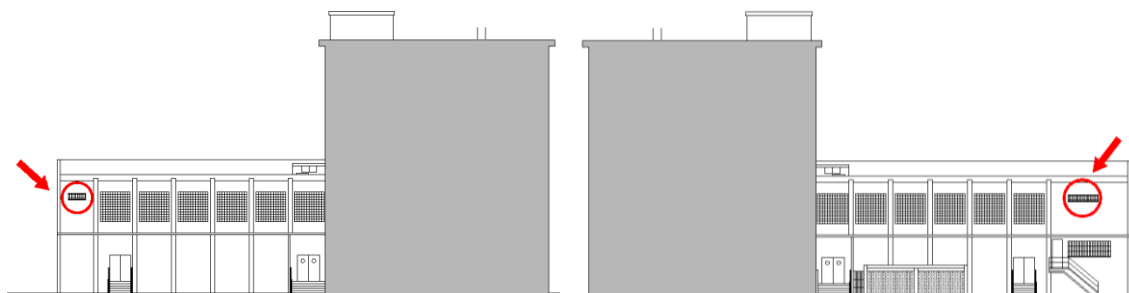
y 22. Ventanas superiores del escenario colocadas en fachada sur y fachada norte.
